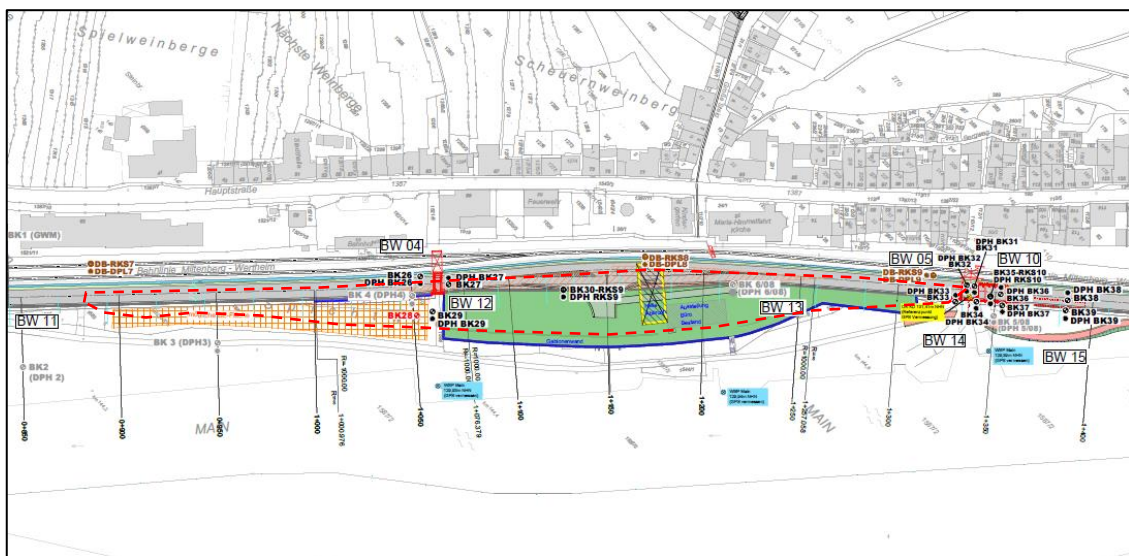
Lageplan der Aufschlüsse im Plangebiet
